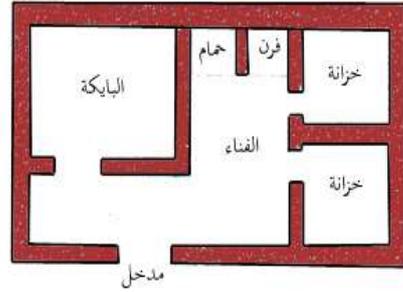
المسقط الأفقي لبيت الصايغ، حي الزيتون
